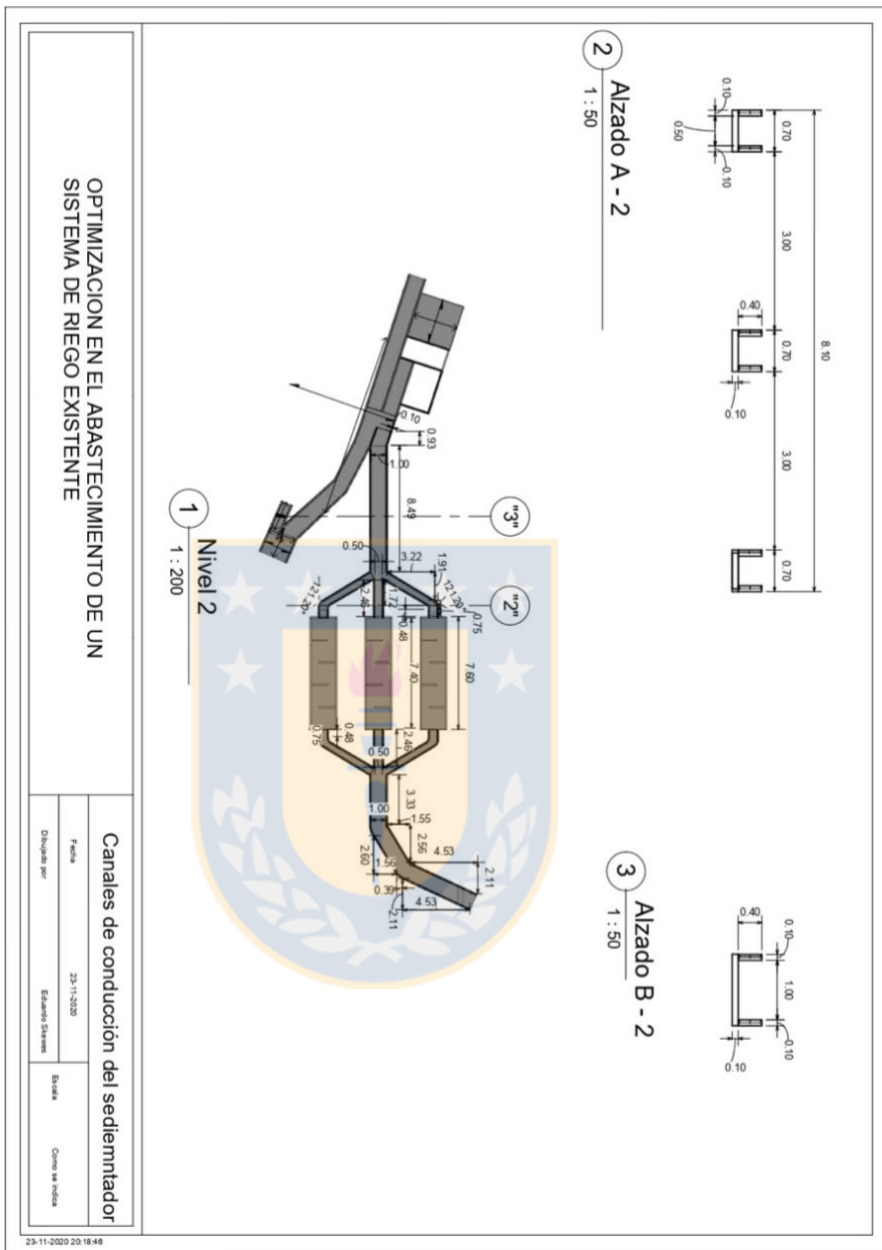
Plano de planta de sedimentadores proyectados. Fuente: Elaboración propia.
